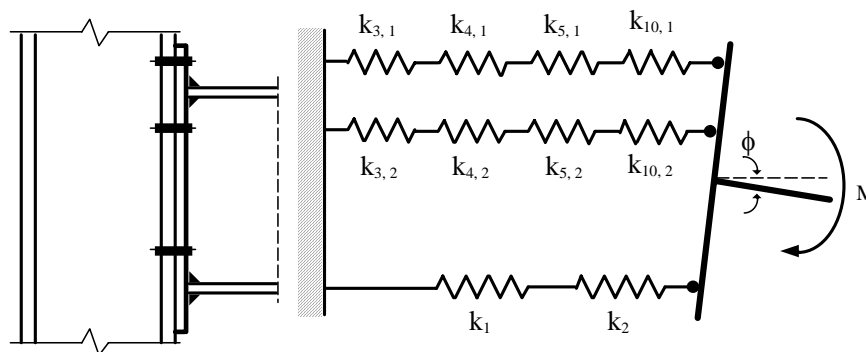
Método das componentes aplicado a uma ligação viga pilar aparafusada
